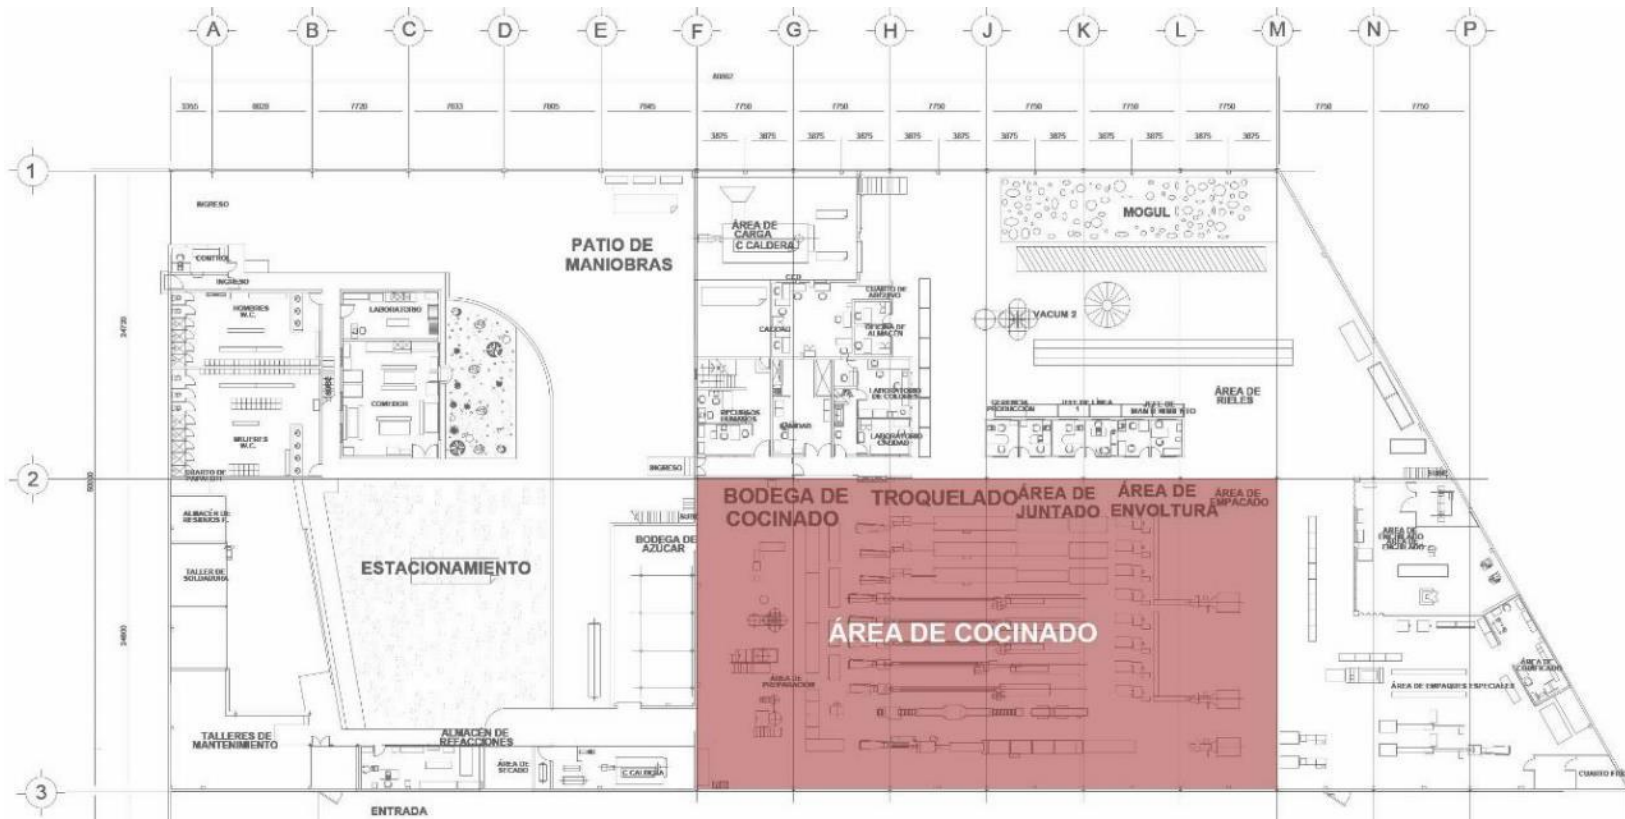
Planta arquitectónica de fábrica 2 con área de análisis delimitada. Elaboración propia.
